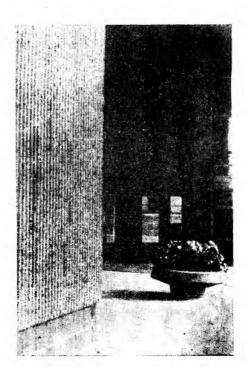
Тротуары и пешеходные переходы, покрытые фигурными элементами мощения из песчаного бетона, с установкой на них цветочниц со вскрытием структуры
